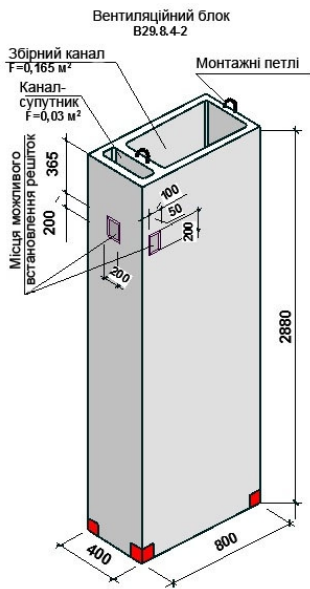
Уніфікований залізобетонний вентиляційний блок
